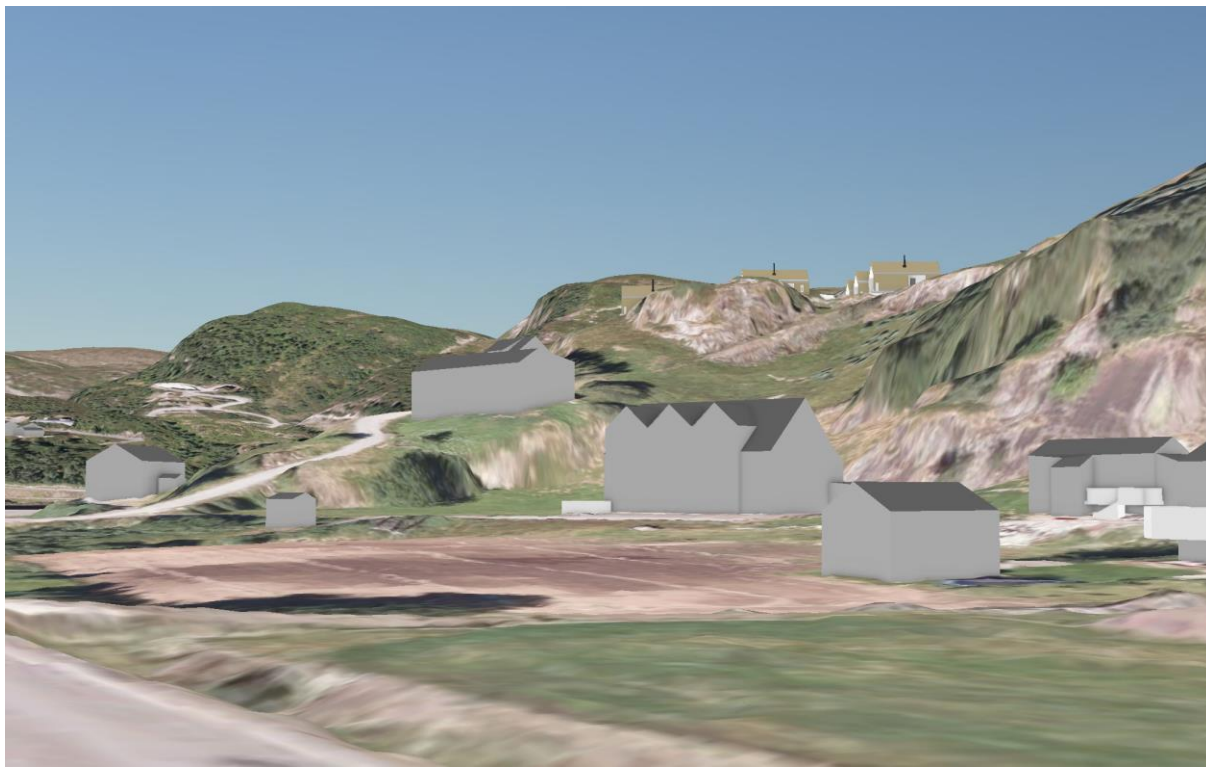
Planlagt bebyggelse uten vegetasjon sett fra fylkesveien øst for planområdet
